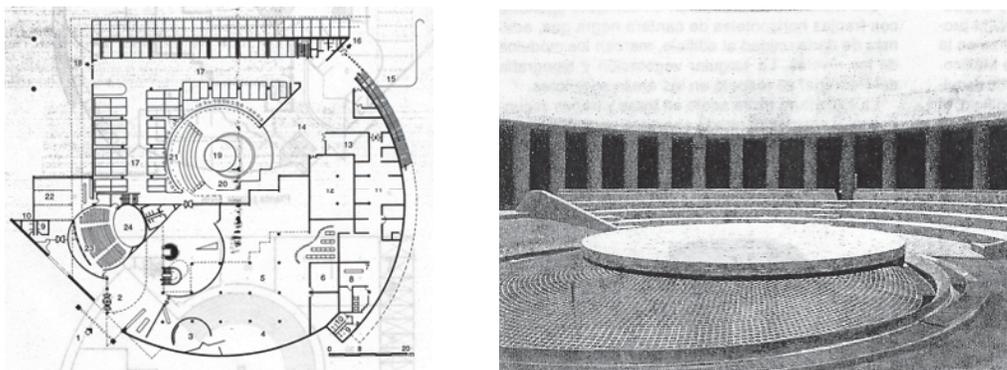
Planta y Patio Central Biblioteca Central y Archivo General del Estado, Orso Núñez Ruiz Velasco.
